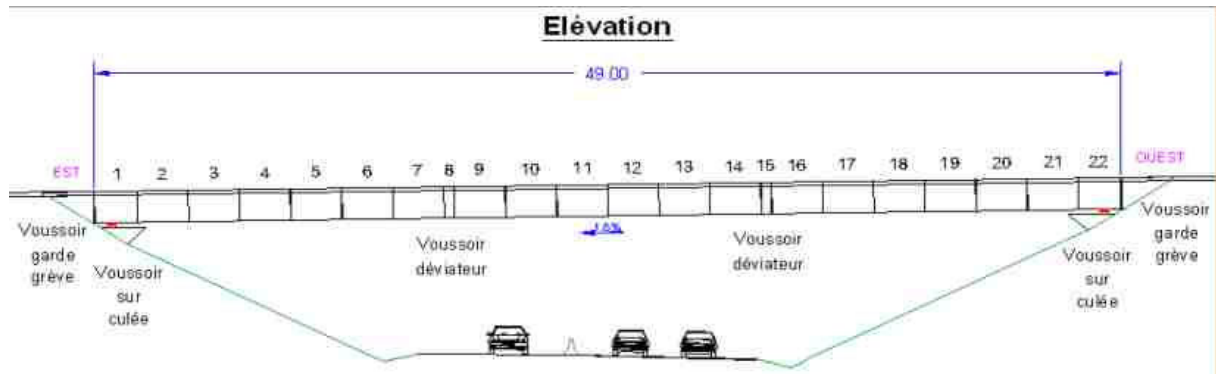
Coupe longitudinale de l'ouvrage / Longitudinal cross-section of the bridge
